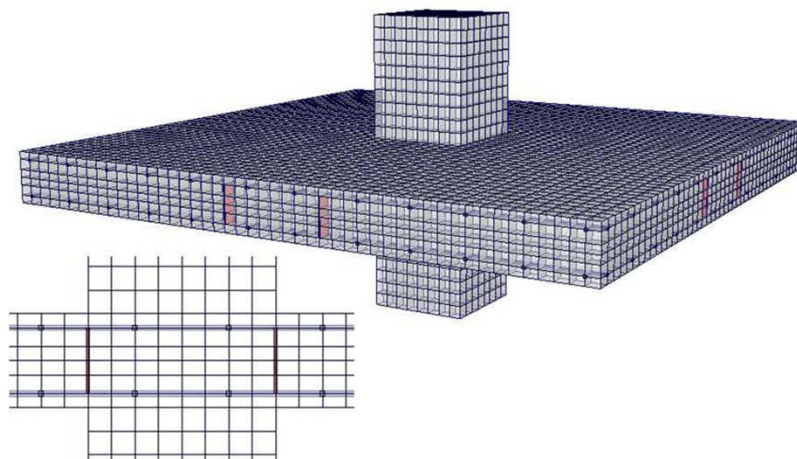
Фрагмент уточненной модели узла сопряжения колонны и плиты перекрытия с жесткой арматуры в виде четырех пластин
